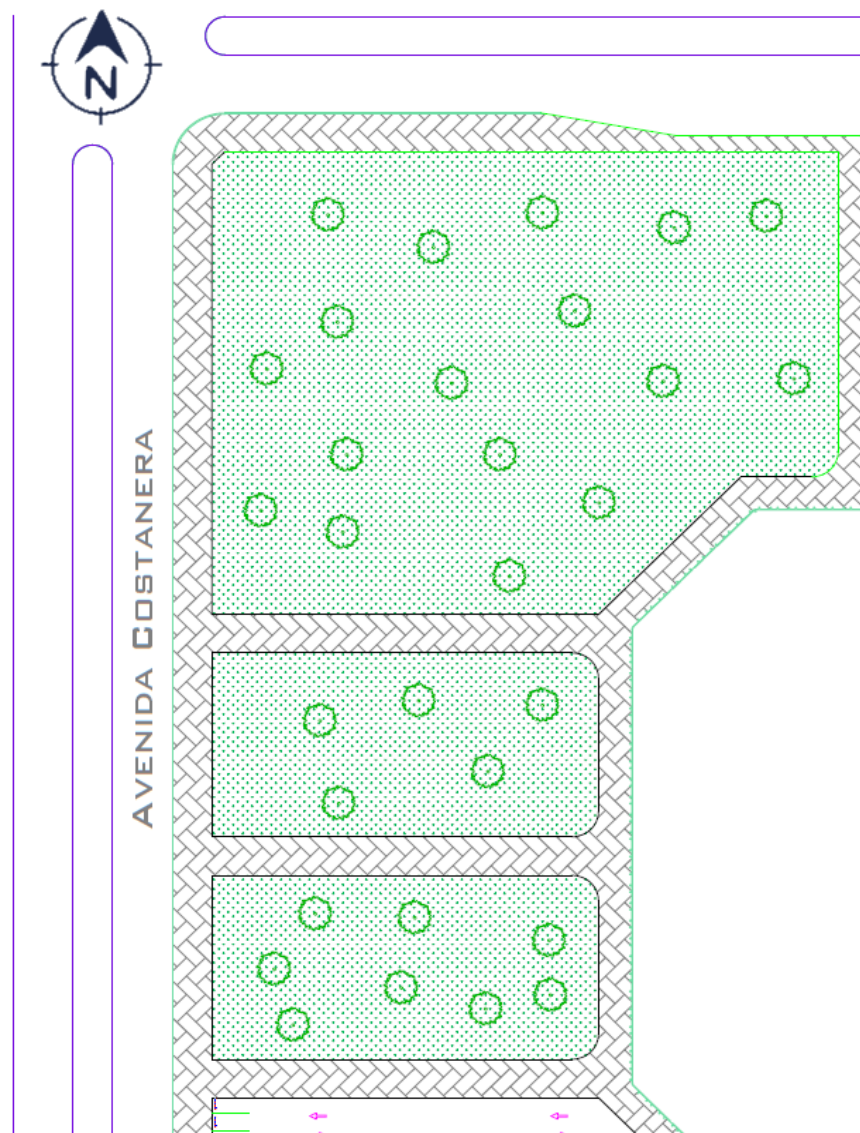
Vista en planta del espacio verde sobre avenida Costanera. Fuente: elaboración propia.
